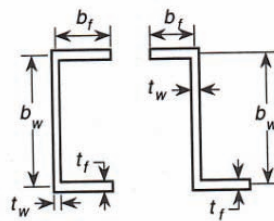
Sezione trave con sezione a Z o channel [23]
